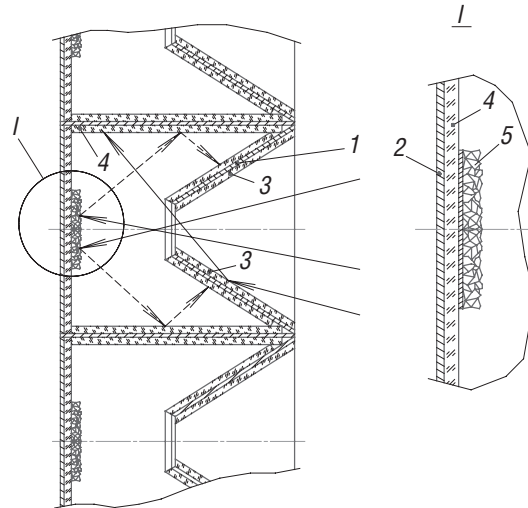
Схема пірамідального екрана, поперечний переріз:
